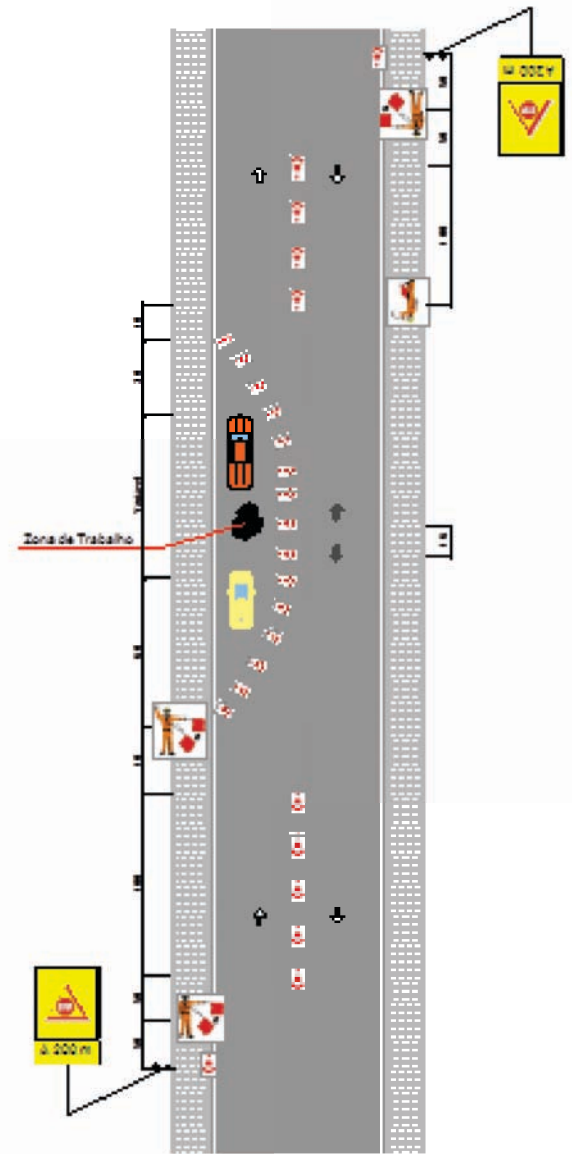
Pista simples - bloqueio de meia pista, circulação alternada
